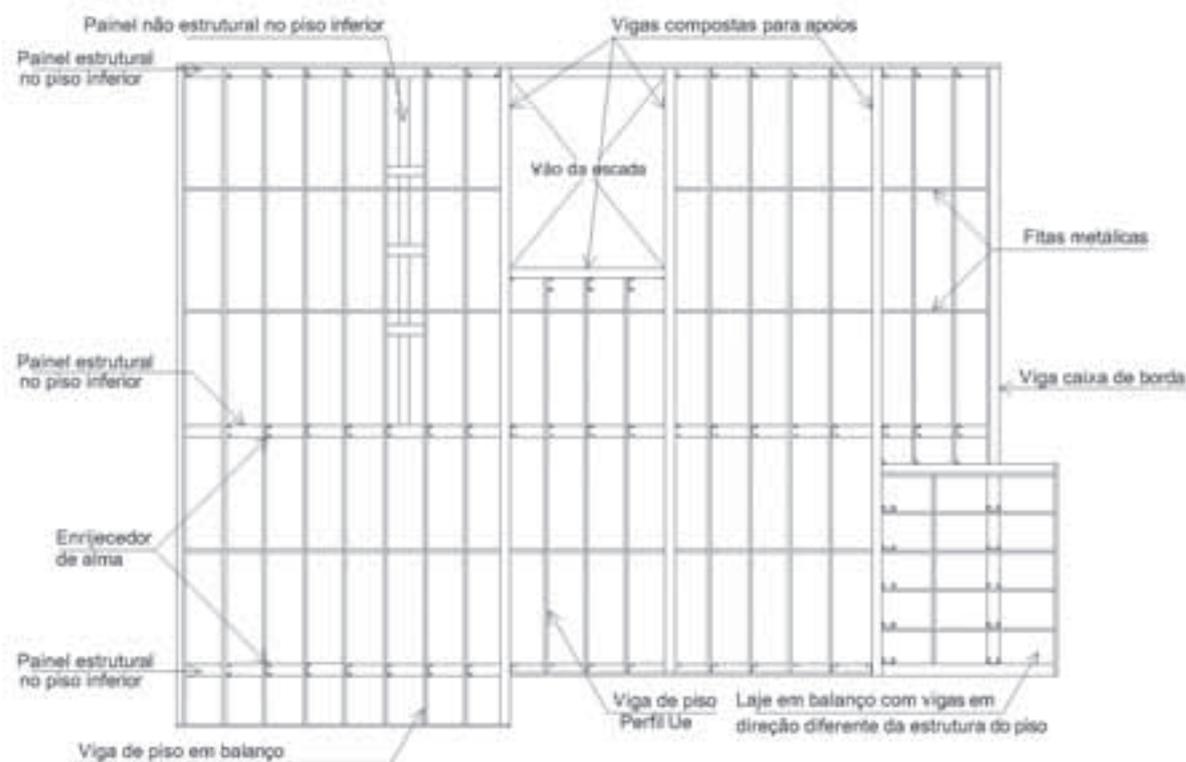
Planta de estrutura de piso em Light Steel Framing
